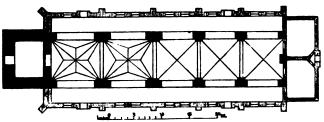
Loits. S. Marienkirche. Grundriss. 1:667.
